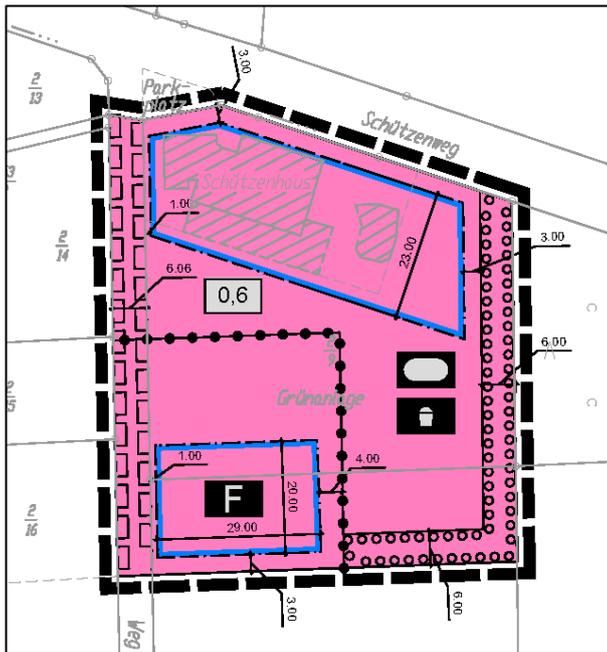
Zeichnerische Darstellung B-Plan Nr. 24 „Schützenweg“ (Ursprungsplan)
